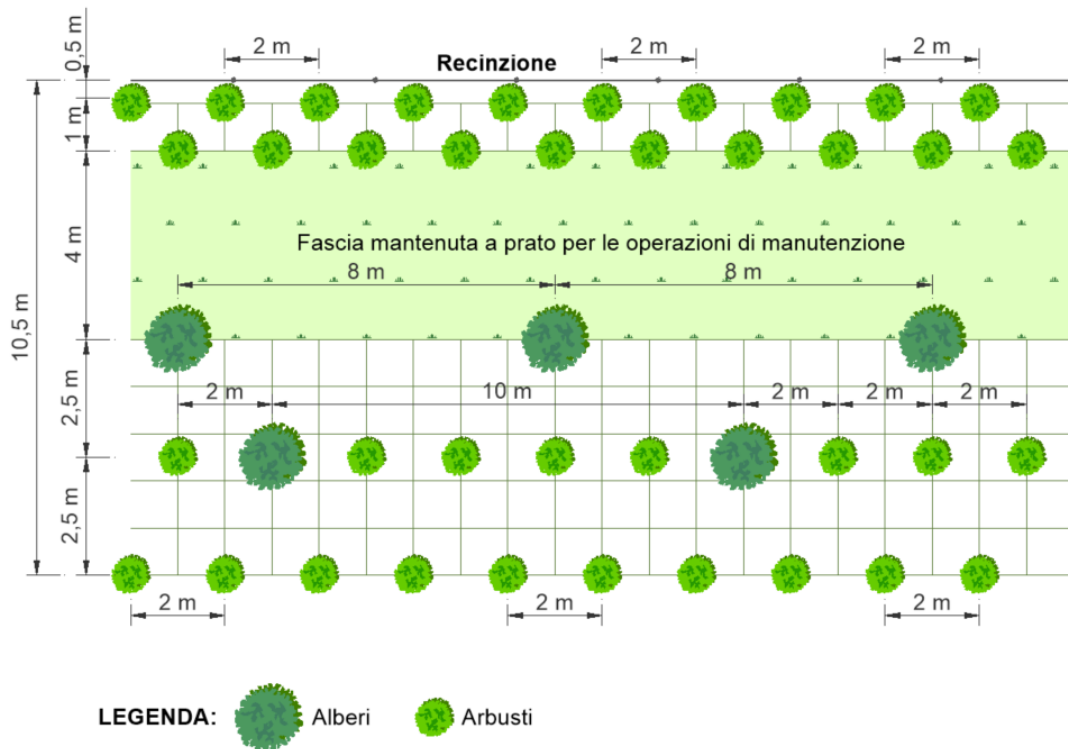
Schema d'impianto della barriera a verde in progetto.
